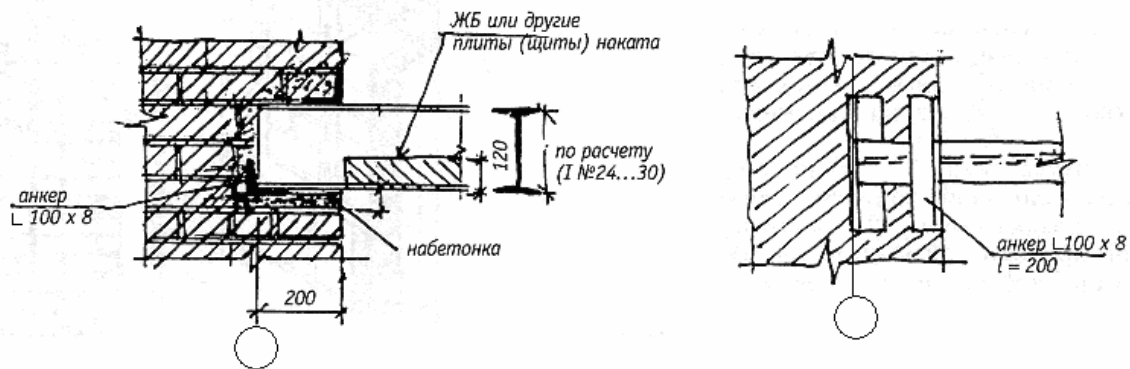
Опираие стальных двутавровых балок на каменные стены
